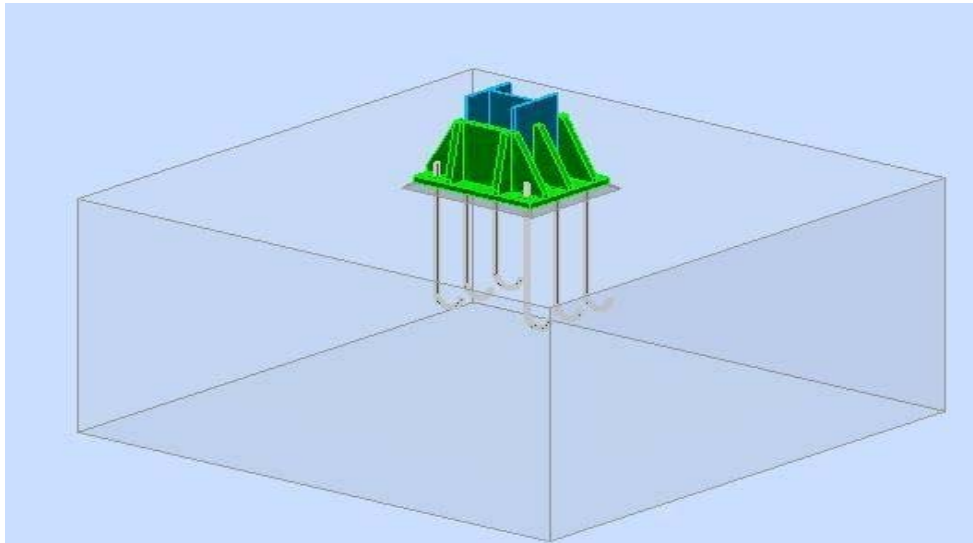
Vue 3D d'assemblage pied de poteau
